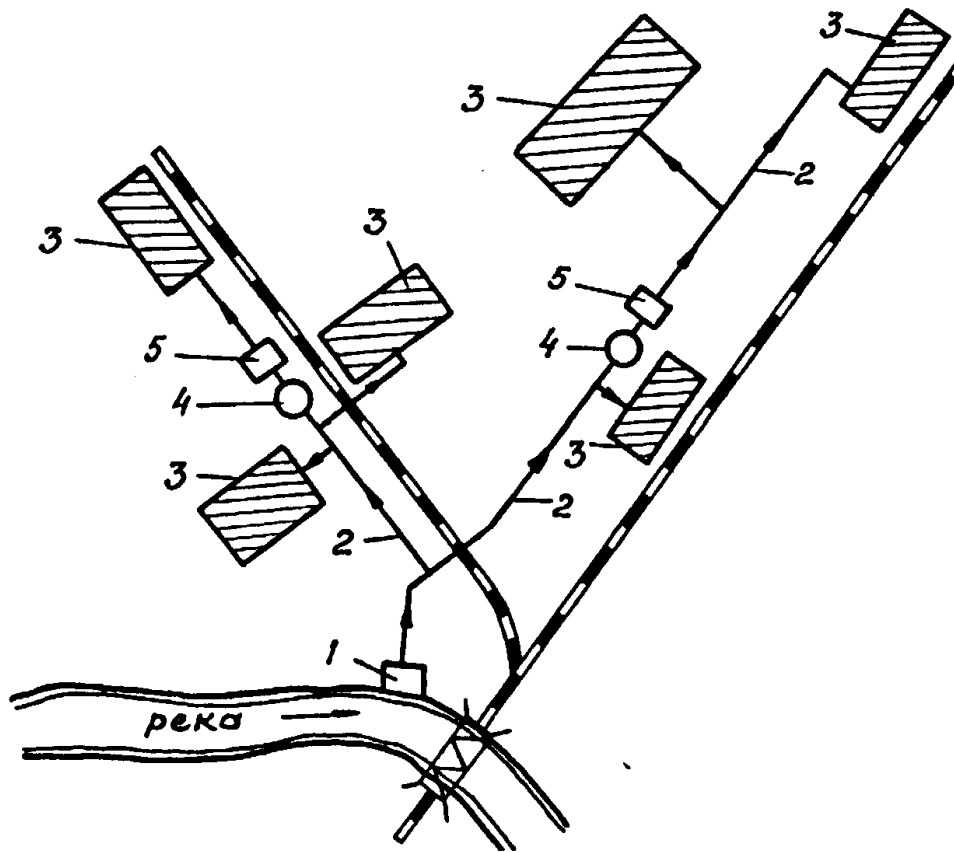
Схема водоснабжения с групповыми водопроводами: 1 - головные водопроводные сооружения; 2 - напорные трубопроводы; 3 – объекты водоснабжения; 4 - резервуары-накопители чистой воды; 5 - насосные станции
